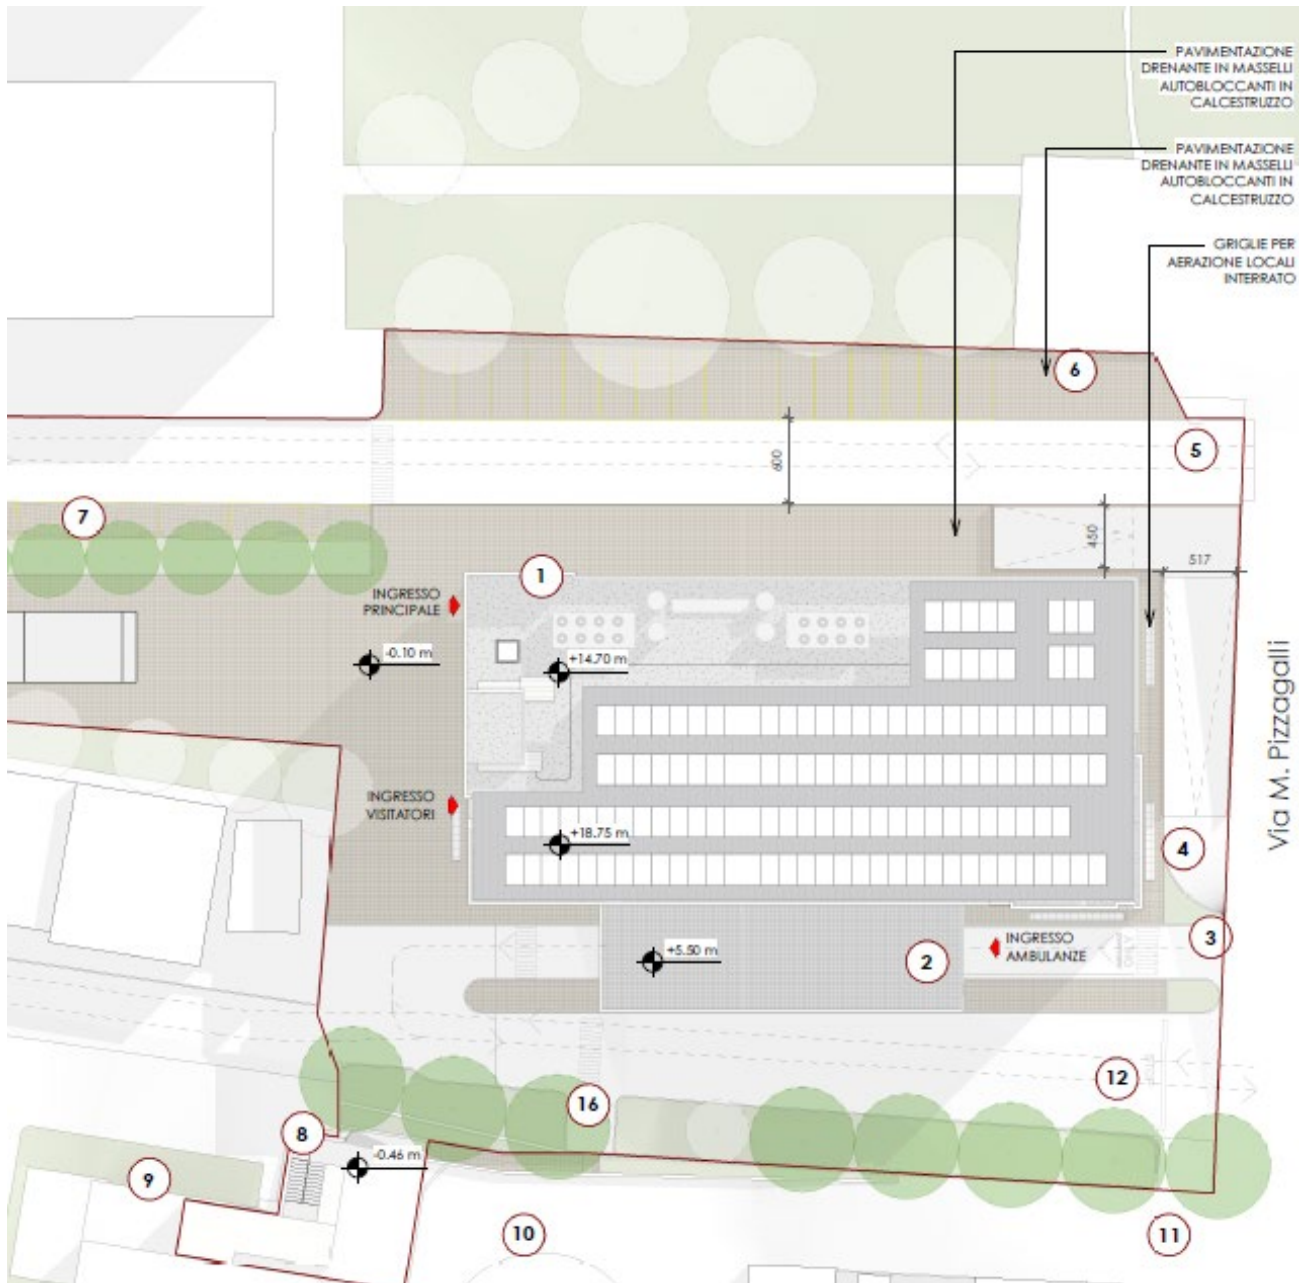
Planimetria delle sistemazioni esterne (area palazzina delle emergenze)
